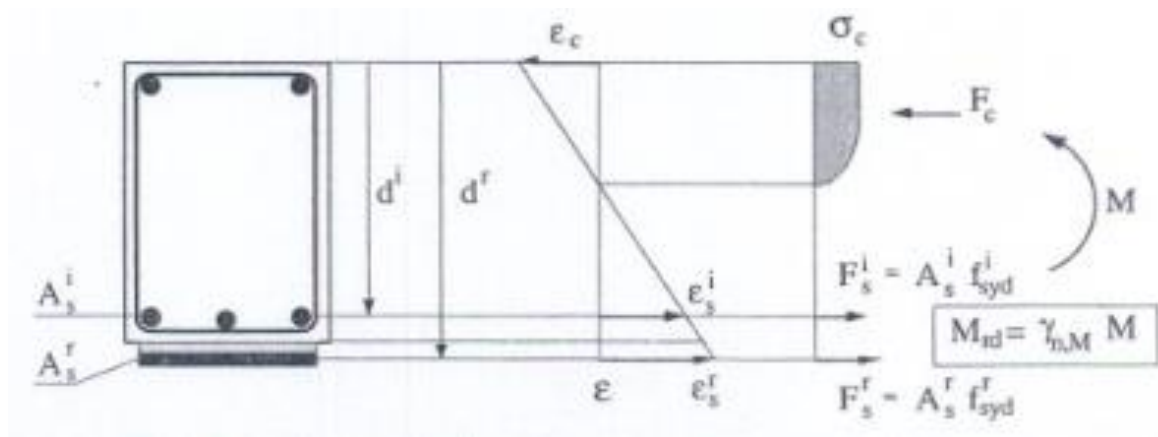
Modelo de cálculo à flexão de vigas reforçadas por colagem de chapas metálicas. (Gomes, A., Appleton, J.).
